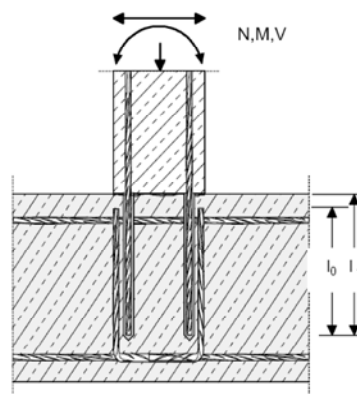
giunzione per sovrapposizione di pilastri sollecitati a flessione o muri a fondazioni.
